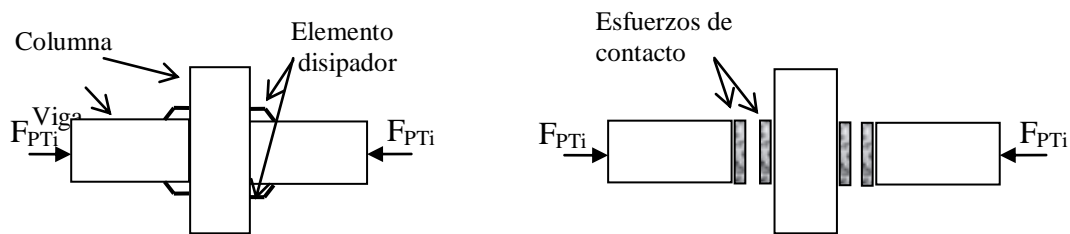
Conexión viga-columna con MPDE, ensamblaje completo y diagrama de cuerpo libre
